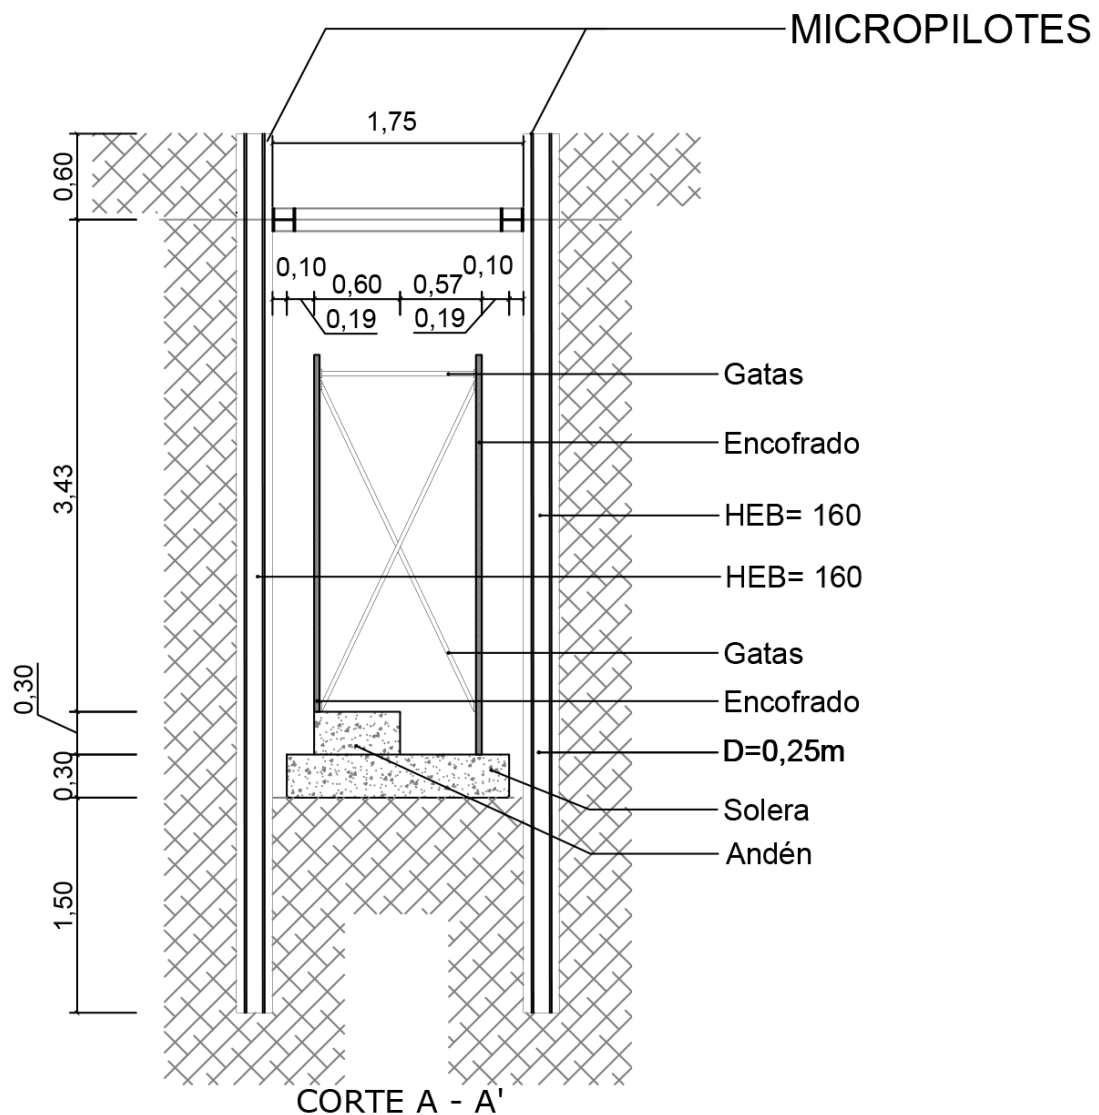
D7-Detalle encofrado losa en sección de tramo 1-2-3
